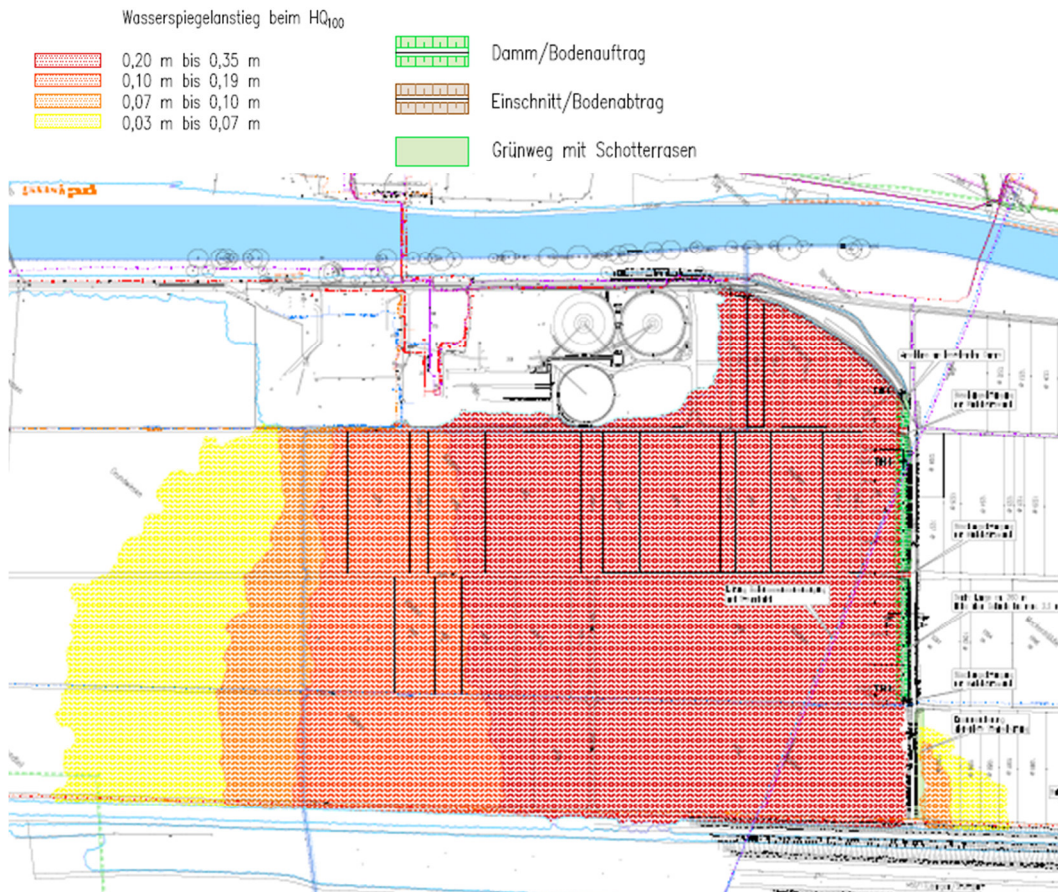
Planung Retentionsraumausgleich an der Kläranlage Tübingen. Lageplan Deichbauwerk Variante I ohne Verschluss (Grundlage: Ausschnitt des Vorabzugs vom 19.03.2015, Ingenieurbüro Winkler und Partner GmbH, Stuttgart).
